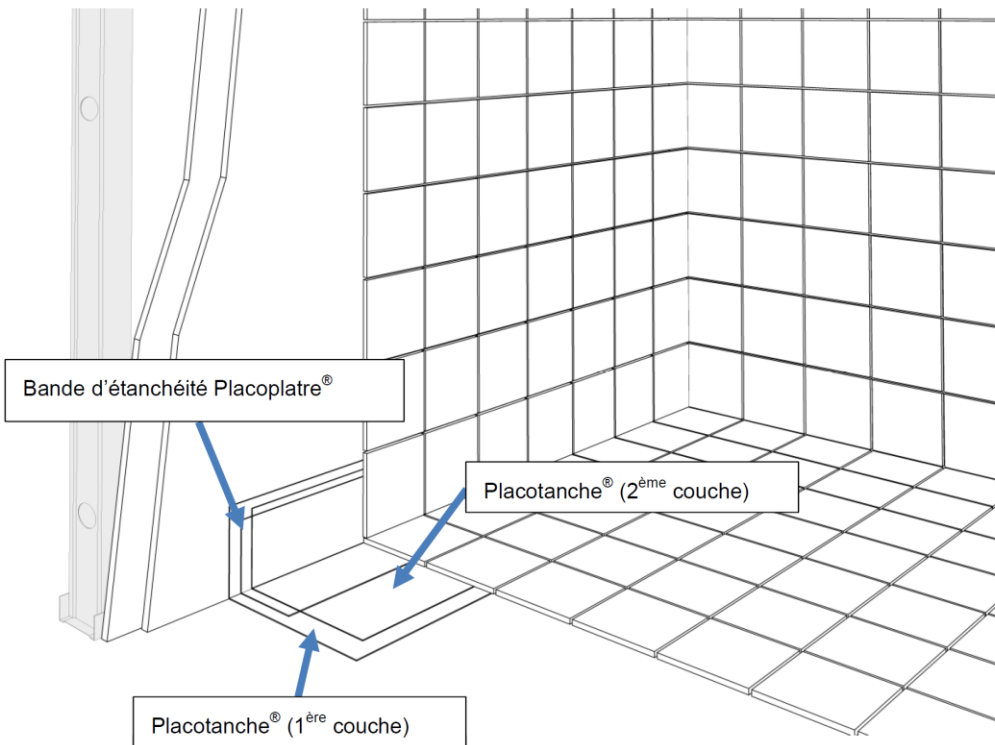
Local EB+ collectif- Protection en pied de cloison (Cas de finition par carrelage collé)
